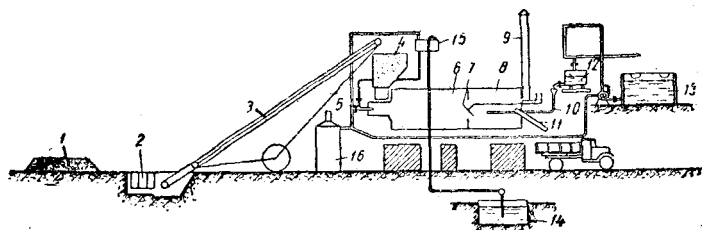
第Ⅰ類瀝青混凝土拌合機製備瀝青混凝土混合料的技術操作過程示意圖：
